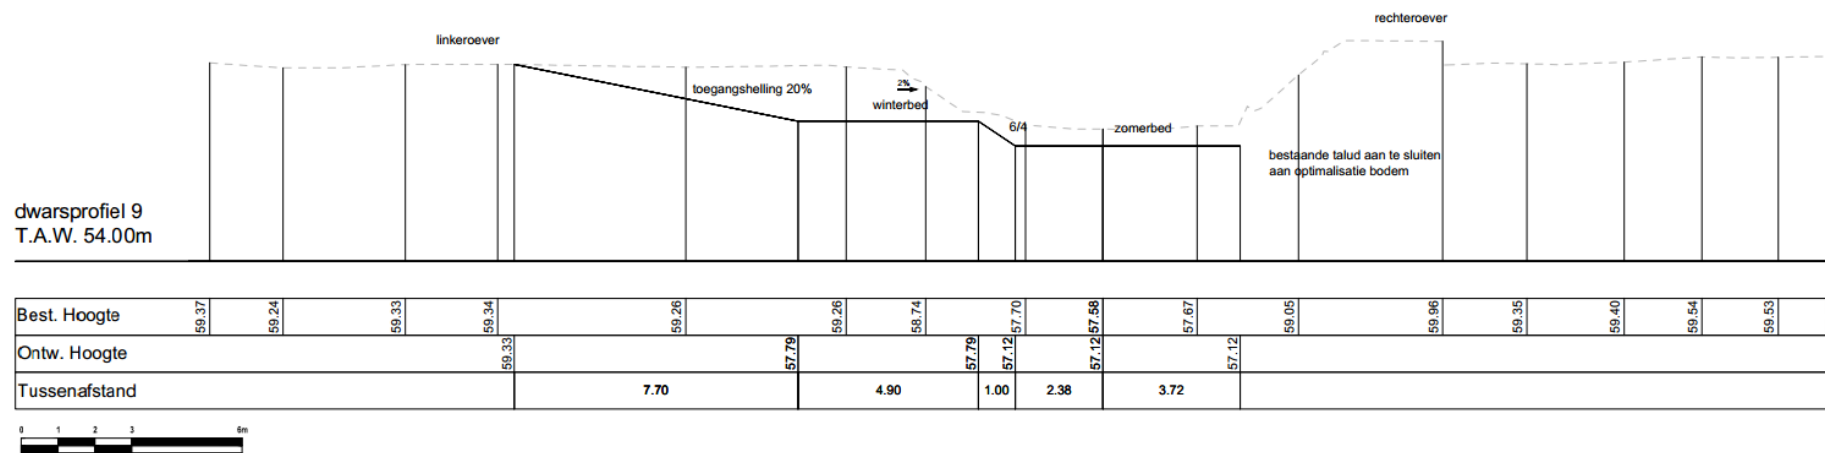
Uitsnede plan geplande toestand (bron: opdrachtgever), zie ook bijlage 2
